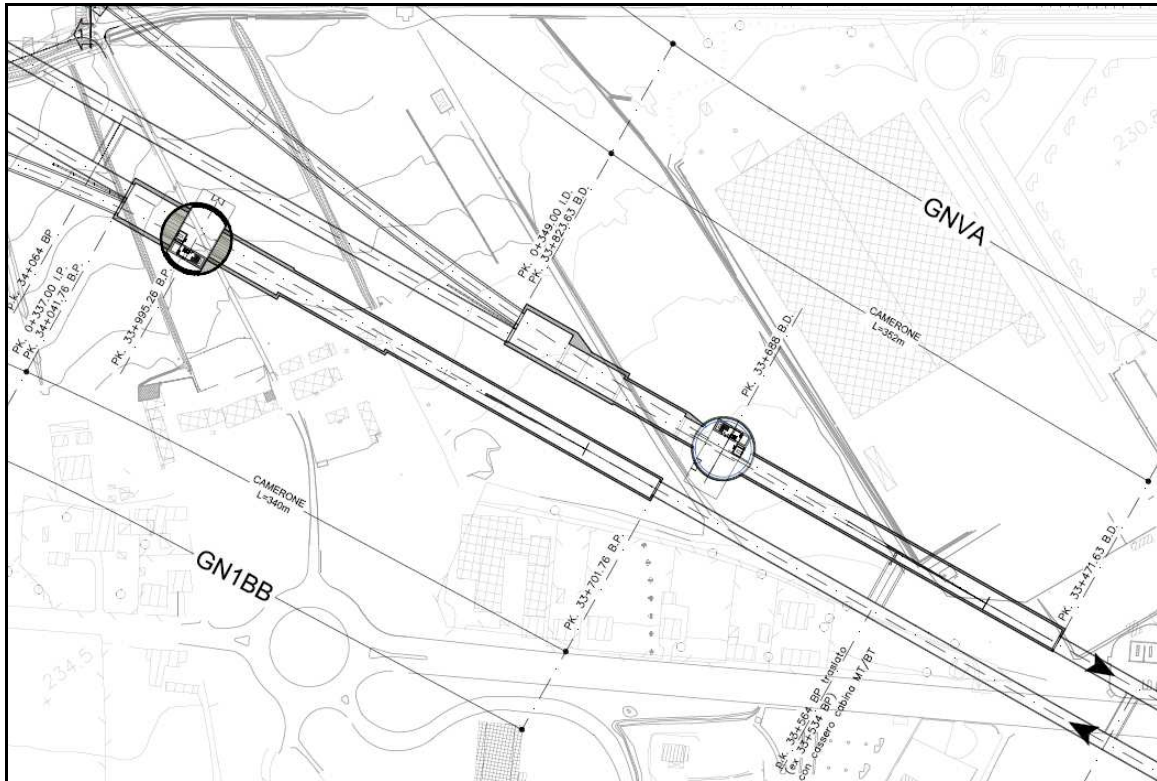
A Schema planimetrico dell'ubicazione delle opere dei cameroni
